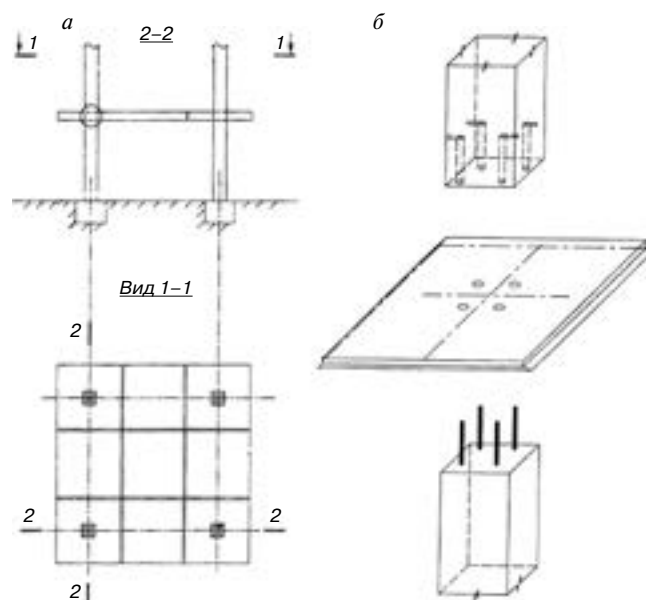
Разрез и план (а) перекрытия со штепсельным соединением надколонной плиты с колонной (б)
